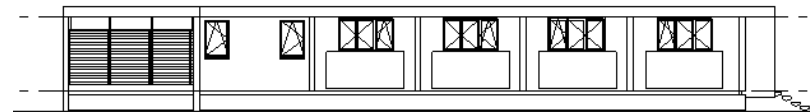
Fachada Posterior de la Vivienda Nader., Fuente: Digitación propia, extraído de interpretación de planos base en Revista AAA/ Edición 47
